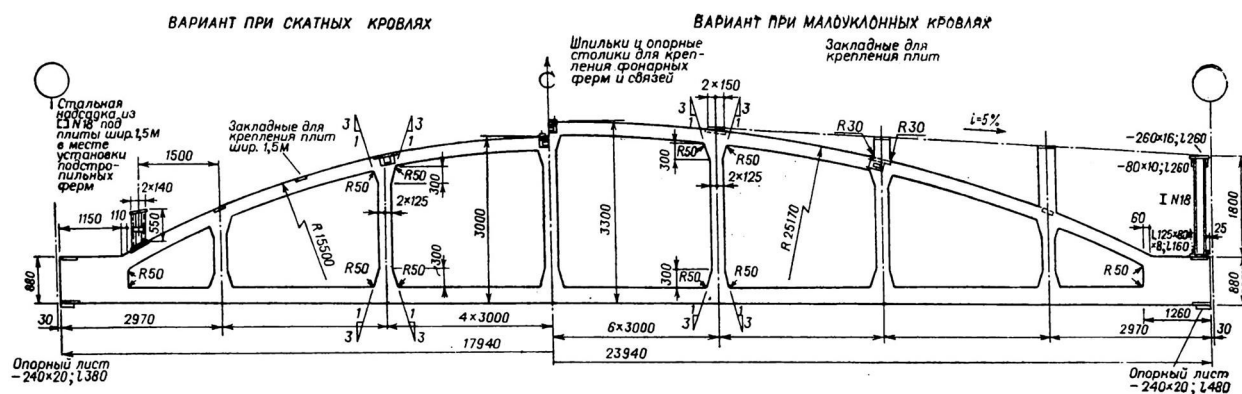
Железобетонные безраскосные фермы для плоских и скатных кровель пролетом 18 и 24 м (серия 1.463-3)
